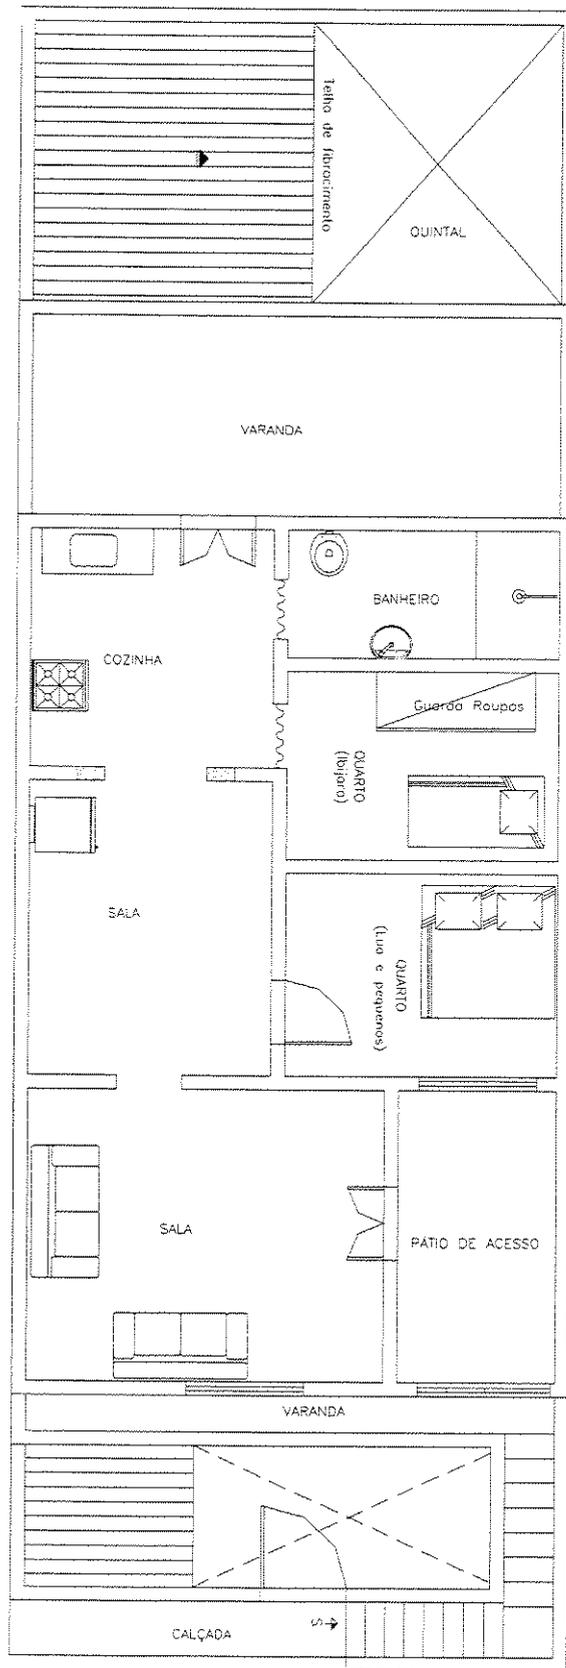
Projeto original do pavimento inferior da casa de Mãe Dialunda – por volta de 1960.
